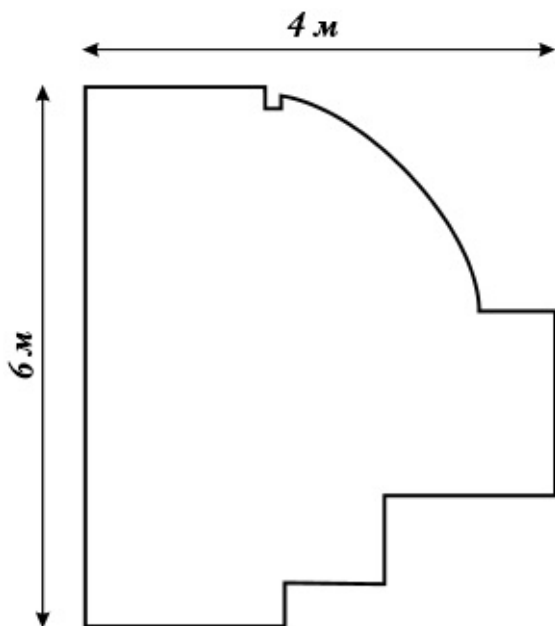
Замер базовой поверхности перед установкой натяжного потолка
